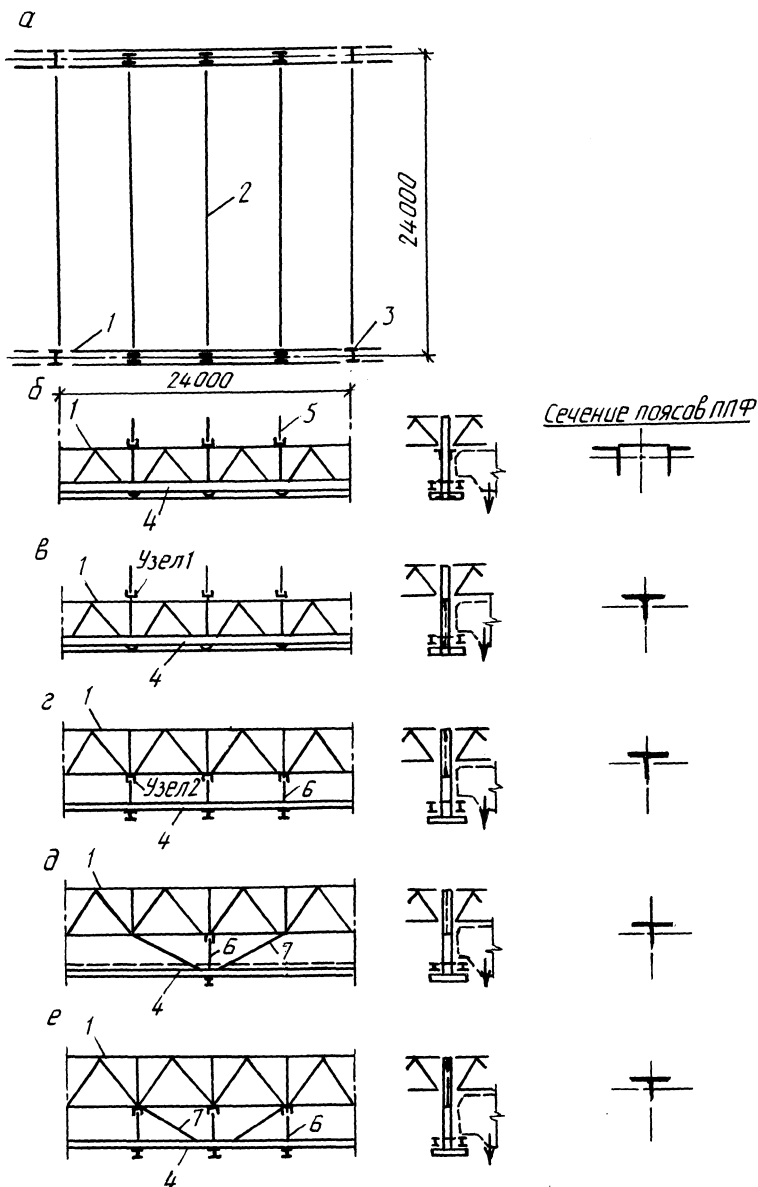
Конструктивные решения подкраново-подстропильных конструкций:
